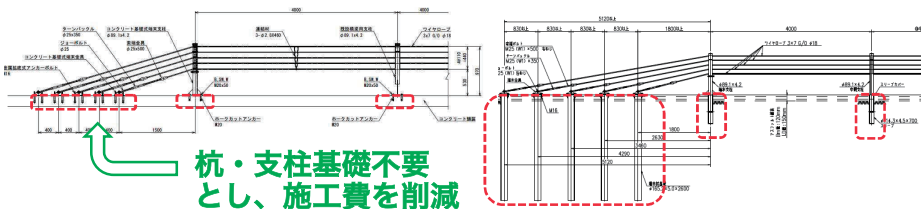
コンクリート舗装仕様（左）と土工部標準仕様（右）
